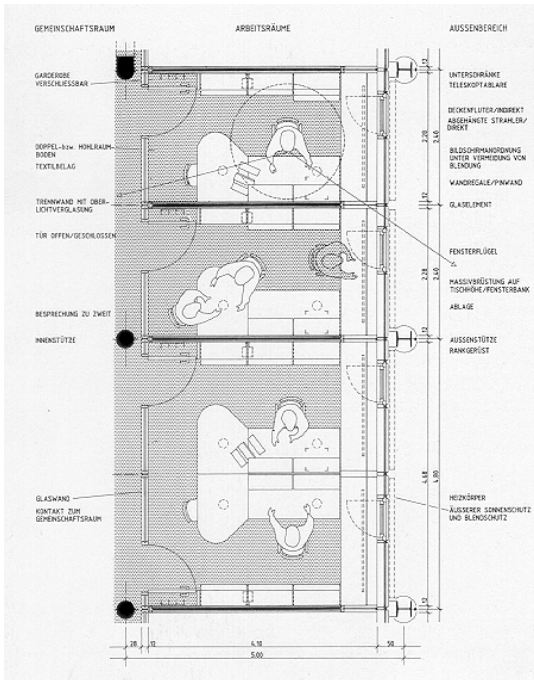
Grundriss + Innenansicht Standardbüro
